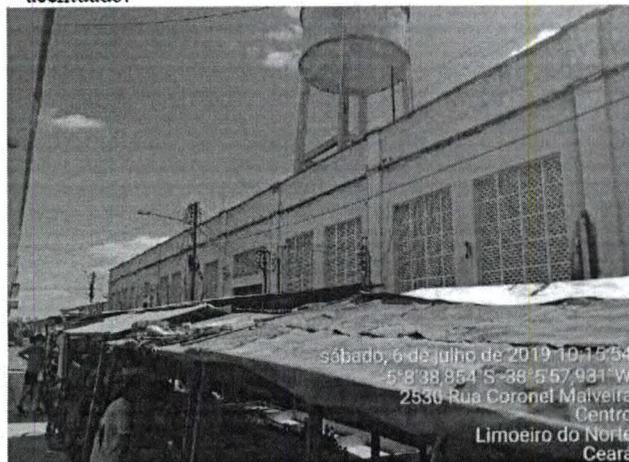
Vista de reservatório apoiado transpassando a cobertura e vista do telhado em telhas de fibrocimento.
